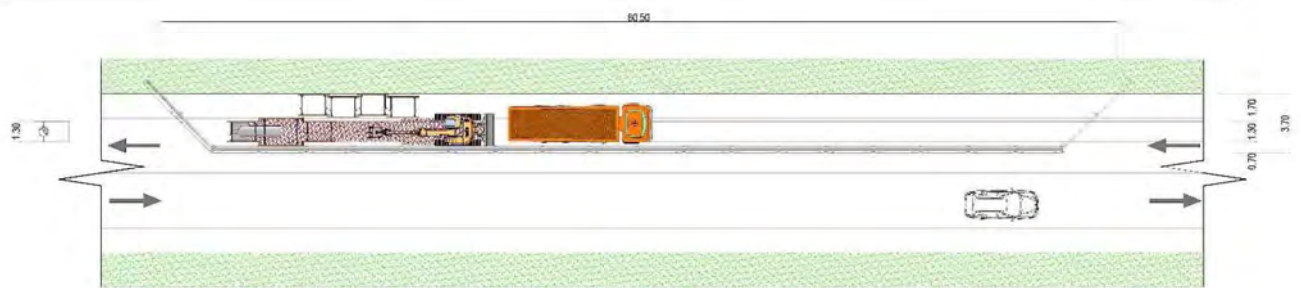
Pianta tipo posa condotte su strada Fase di scavo e posa blindaggi
